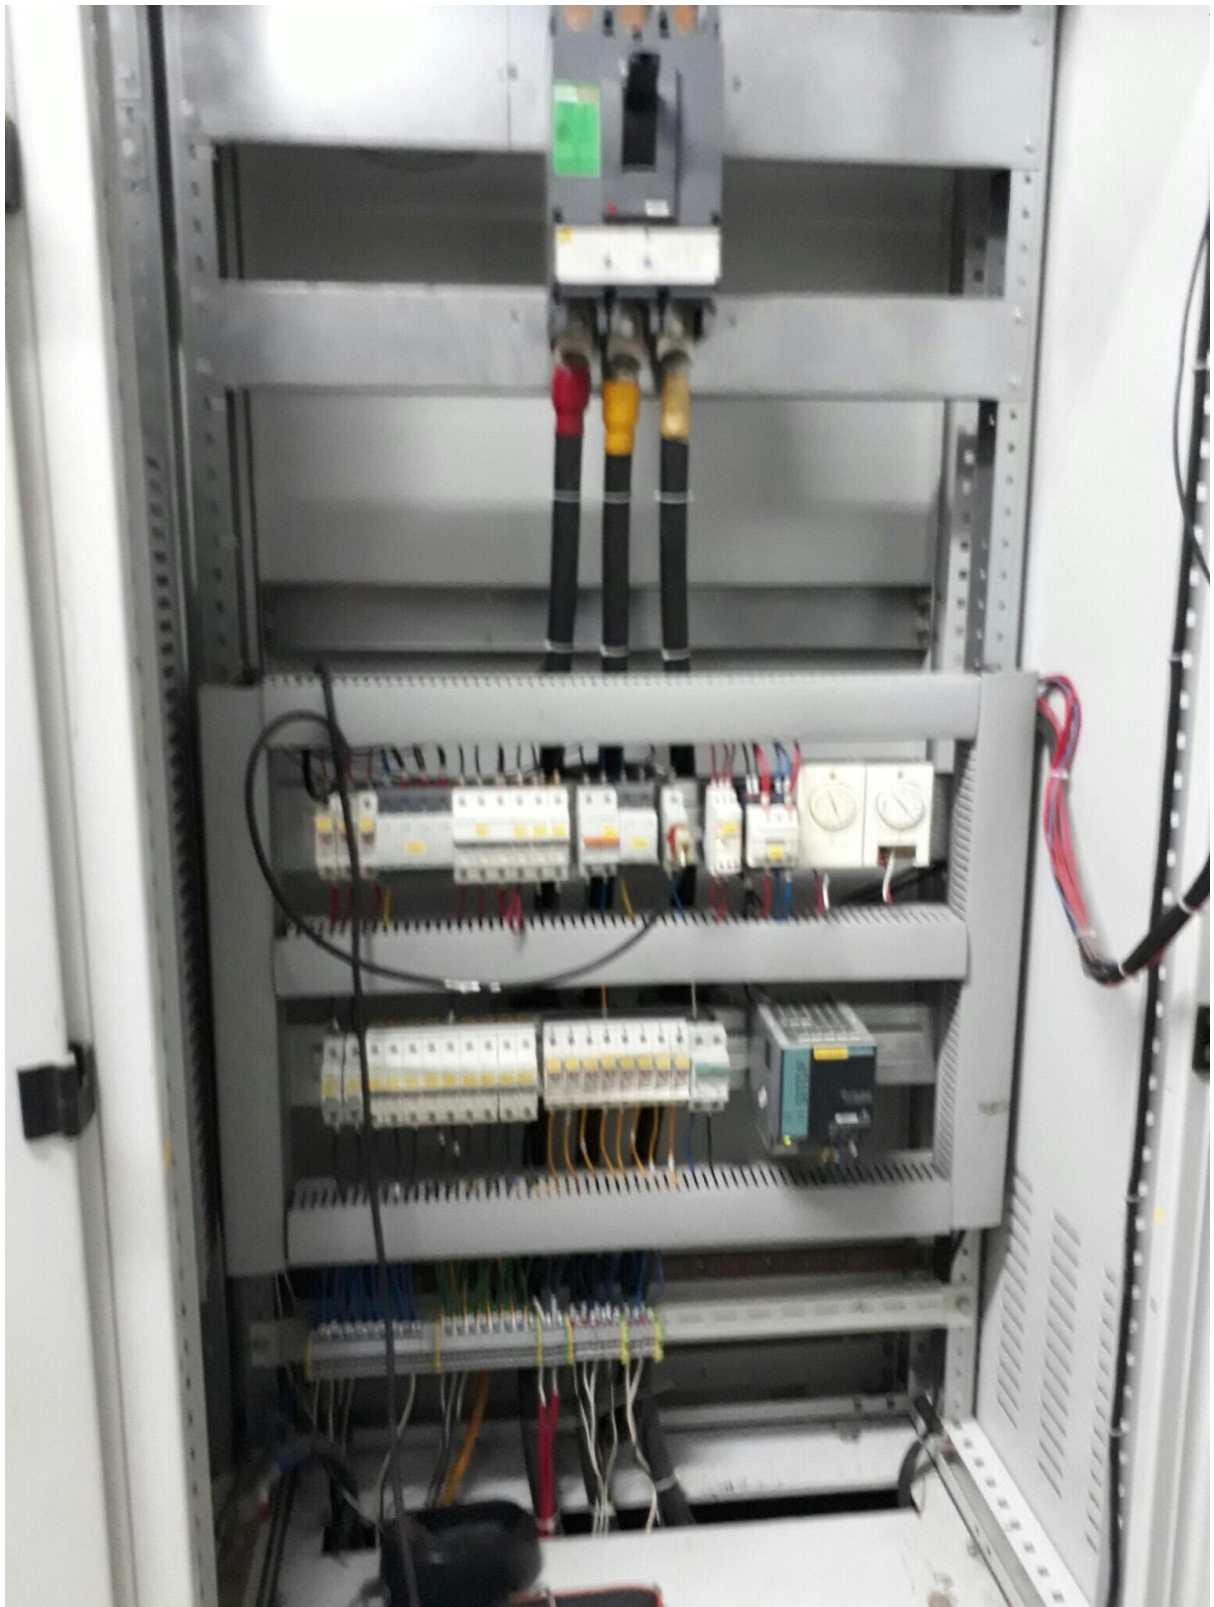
Sơ đồ bố trí mặt tủ.
